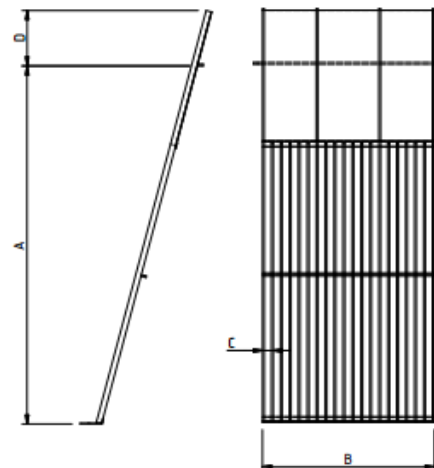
19. Dimensiones y croquis de la reja de gruesos.
